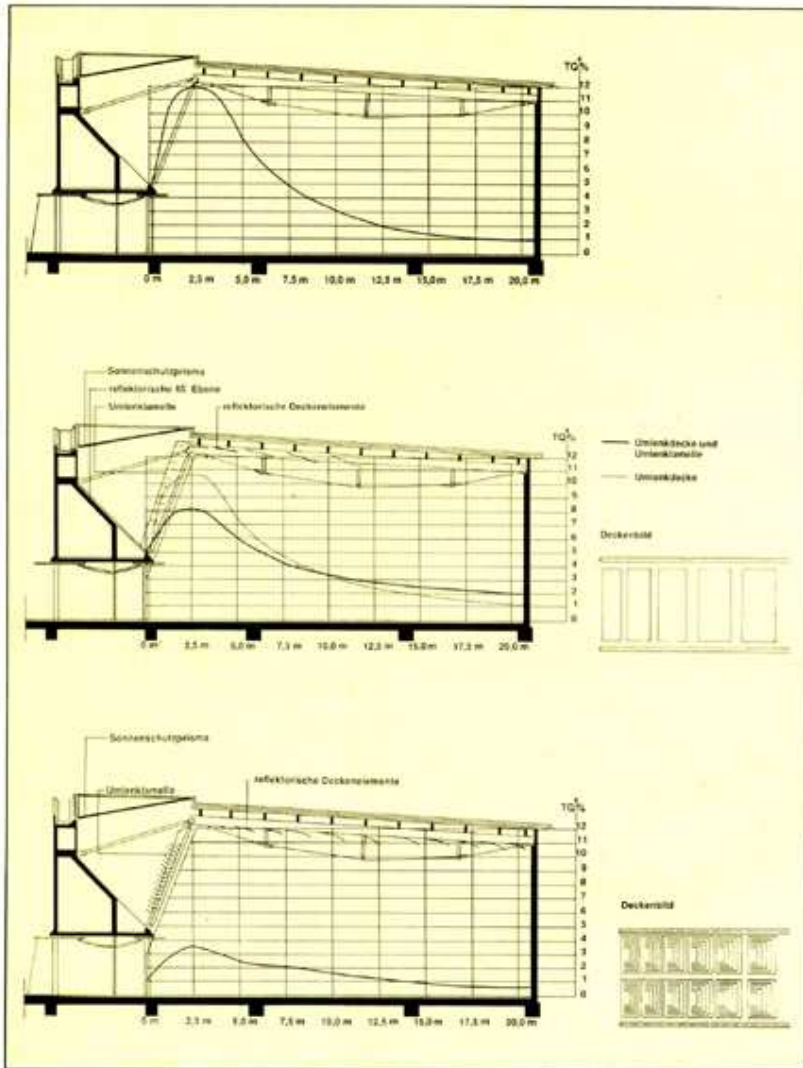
Lichtverteilung im Raum. a) vor Einbau lichtlenkender Systeme; b) mit Umlenkklappen und reflektorischen Deckenelementen; c) verbesserter Versuchsaufbau mit Umlenkklappen und reflektorischen Deckenelementen
